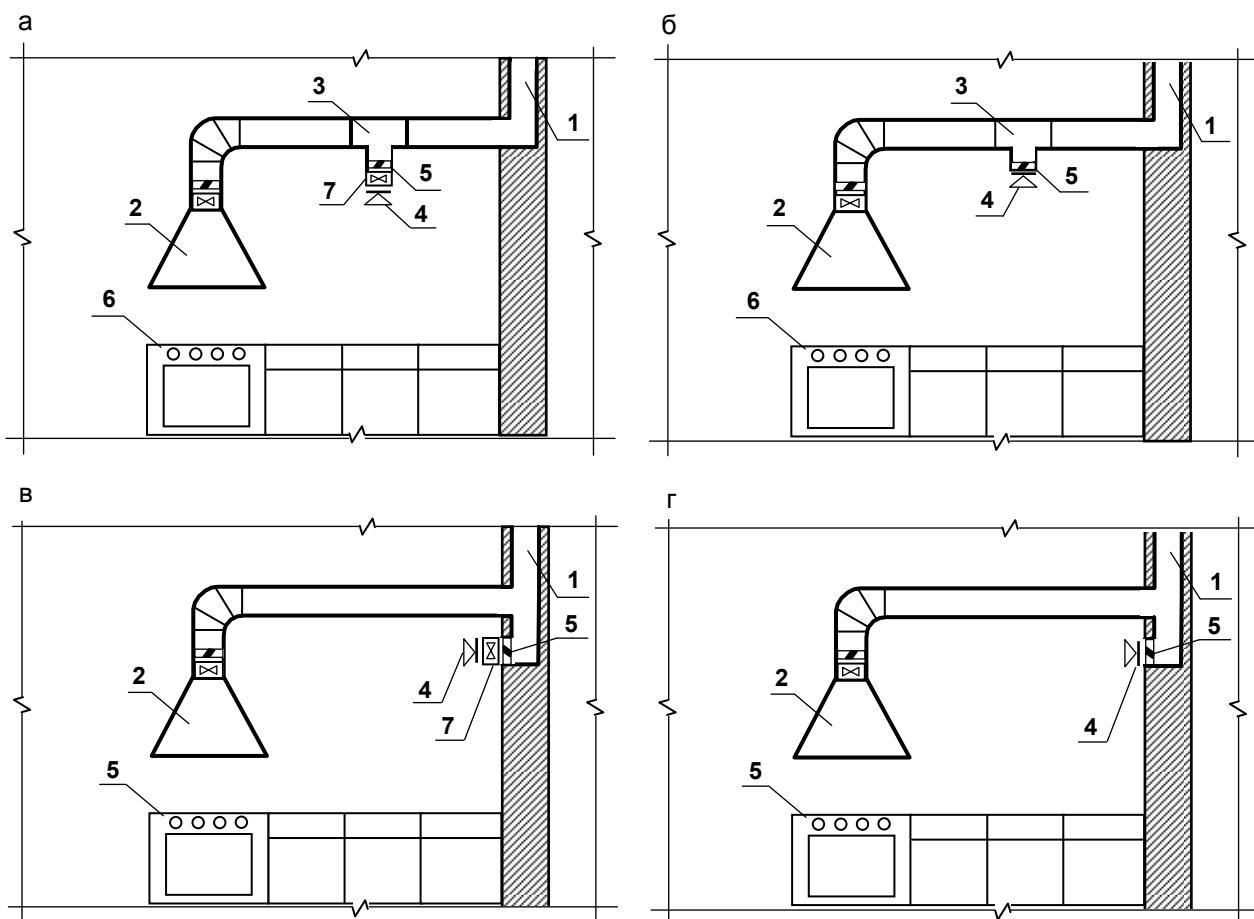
Схемы подключения кухонных вытяжек (вытяжных зонтов с встроенным вентилятором) к вентиляционным каналам: а, в – с дополнительным вентилятором; б, г – без дополнительного вентилятора (1 – вентиляционный канал; 2 – кухонная вытяжка; 3 – тройник; 4 – вытяжная вентиляционная решетка; 5 – обратный клапан; 6 – кухонная плита; 7 – вытяжной вентилятор)
